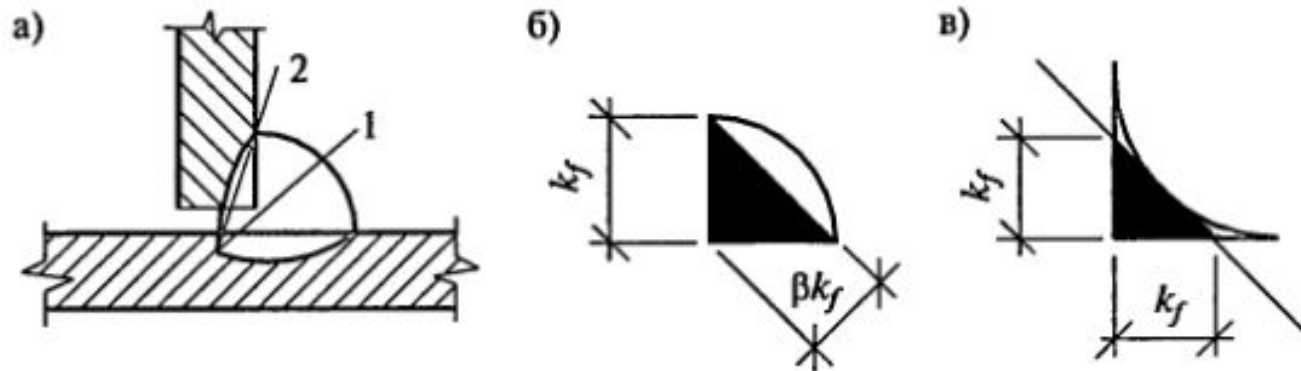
Угловые швы: а) расчетные сечения: 1 — по металлу шва; 2 — по металлу границы сплавления; б) угловой шов; в) угловой шов «в лодочку»; β — коэффициенты по табл. 34* СНИП II-23-81* (соответственно: β_1 для сечения 1 и β_2 для сечения 2)
